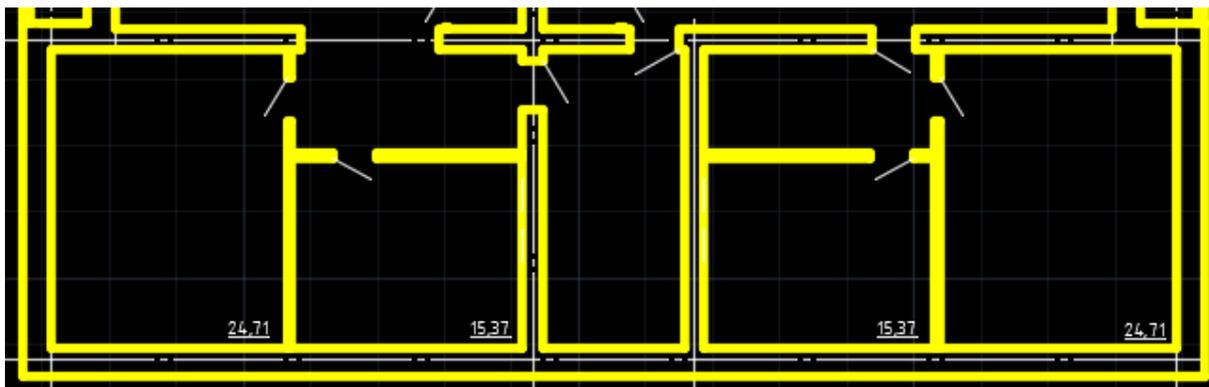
Помещения, окна которых должны располагаться на переднем фасаде
